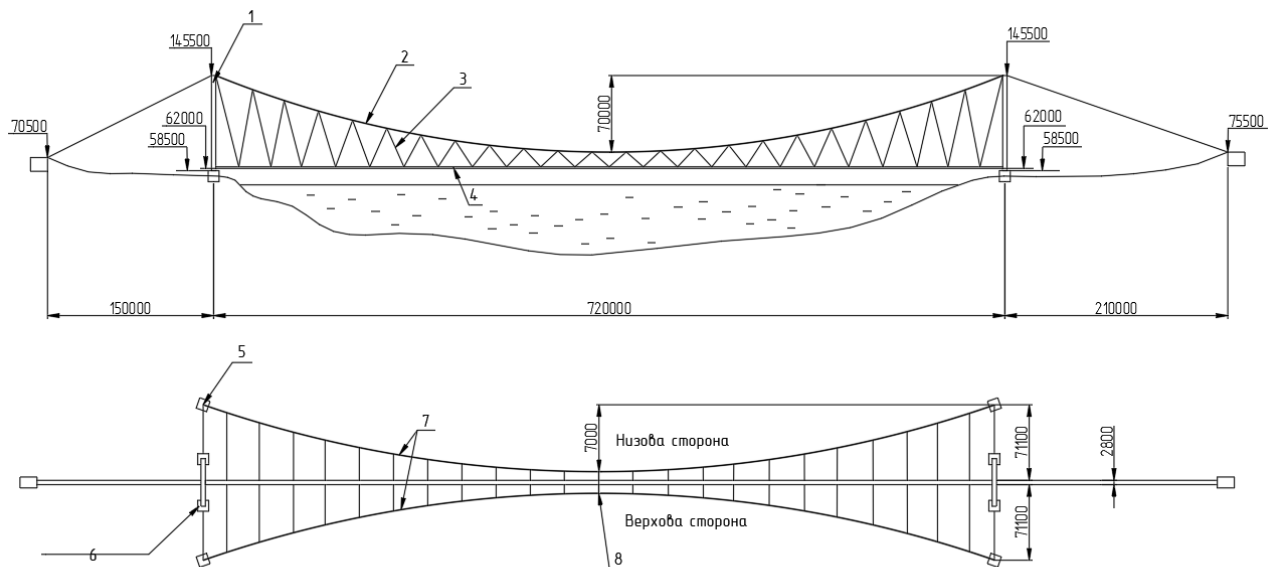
Загальний вигляд. 1. Пілон; 2. Кабель; 3. Підвіска; 4. Ферма; 5. Поясна залізобетонна опора вітрової ферми; 6. Залізобетонна опора пілона; 7. Пояс вітровий; 8. Нерухома опора вітрових поясів ферми
